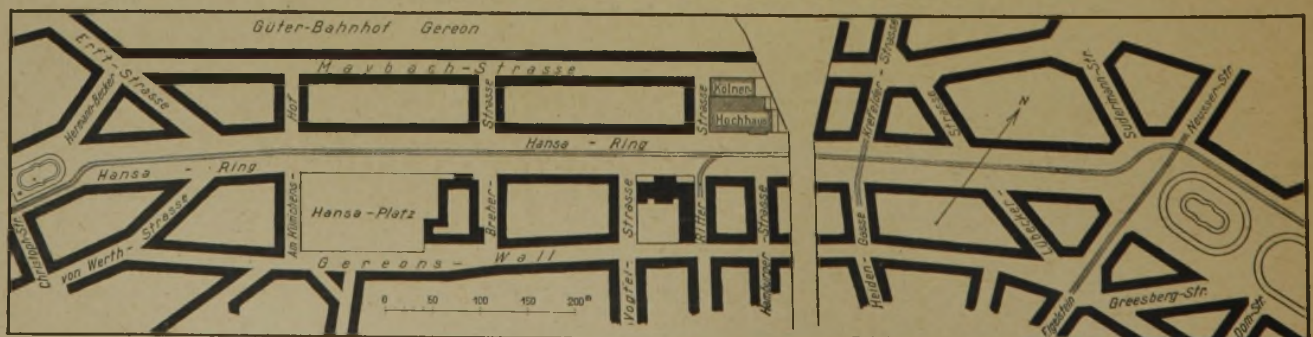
(unten). Lageplan des Hochhauses. 1:8000.
